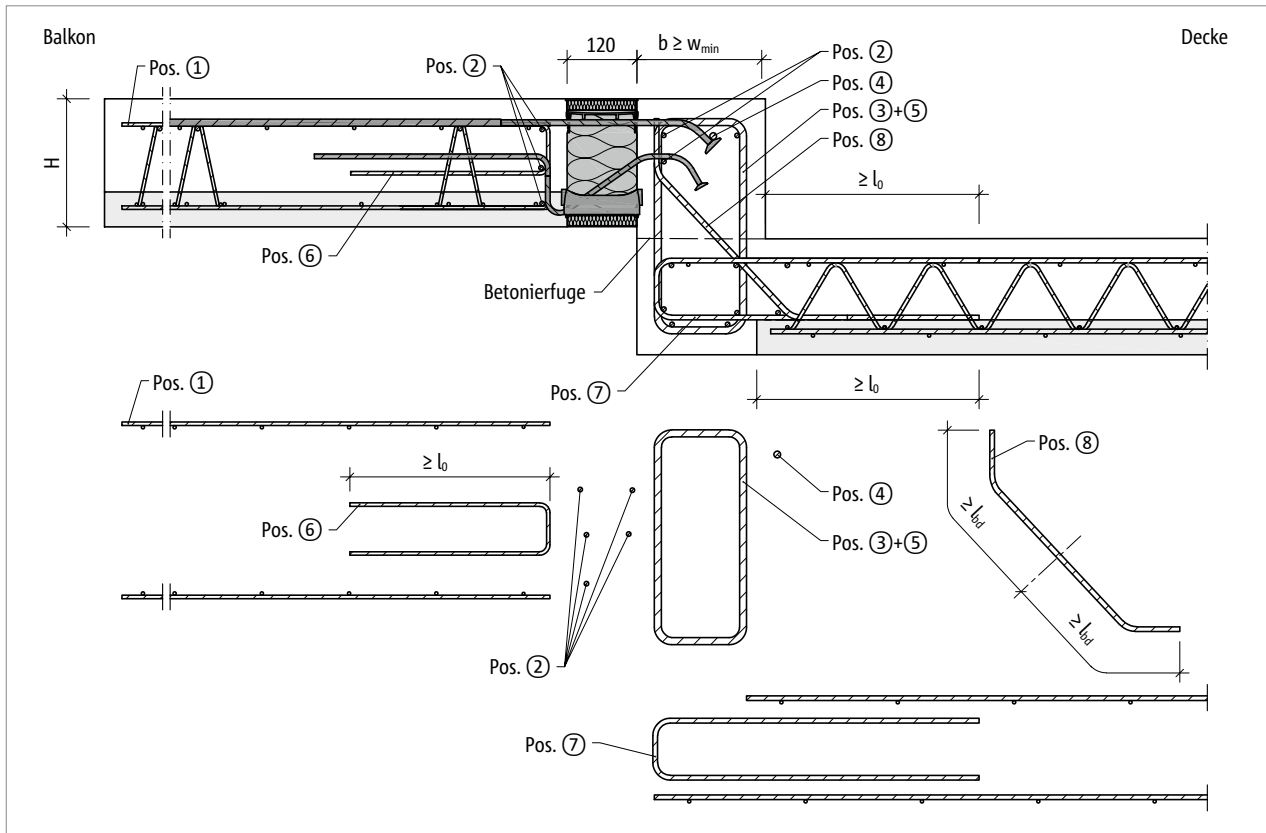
Schöck Isokorb® XT Typ KL-O-F: Bauseitige Bewehrung für Balkon mit Höhenversatz nach oben
